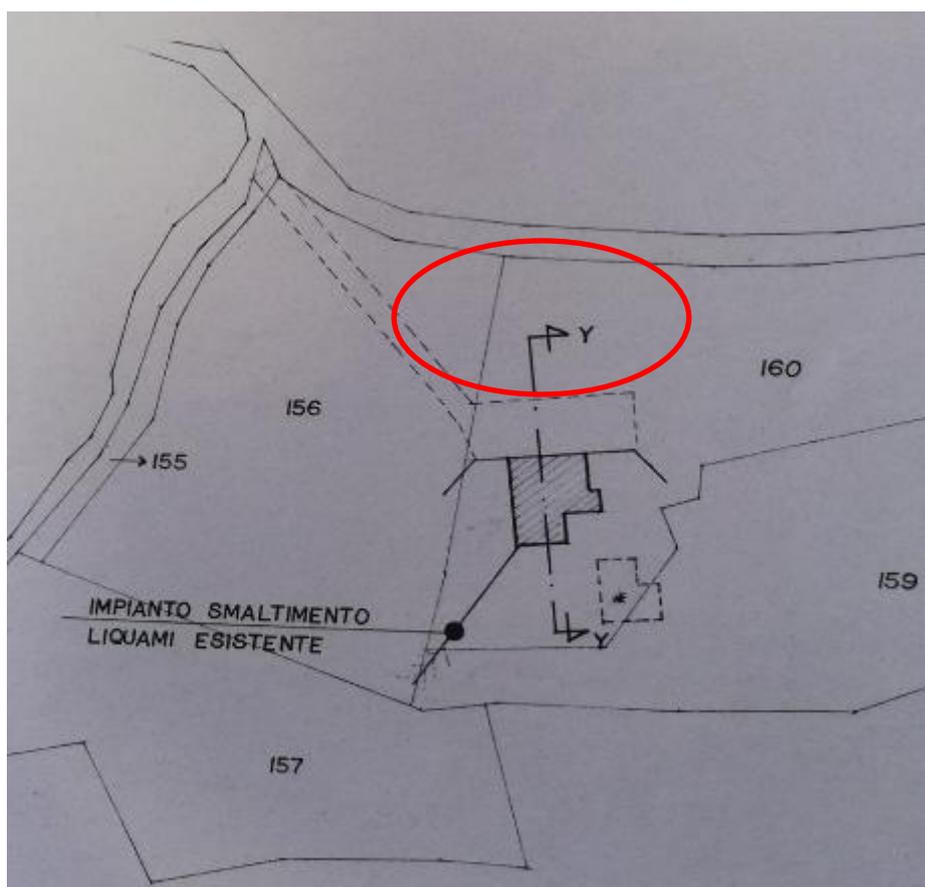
Stralcio del progetto di ristrutturazione e variante del villino (in rosso la posizione dei posti auto esistenti)
